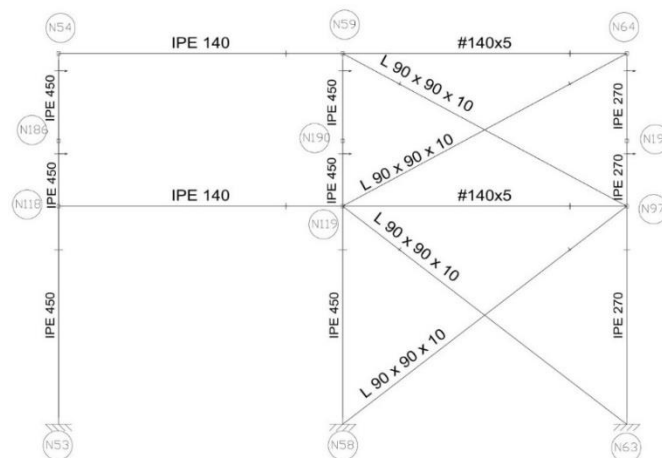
Fachada lateral. Fuente: Elaboración propia a partir de CYPE 3D
